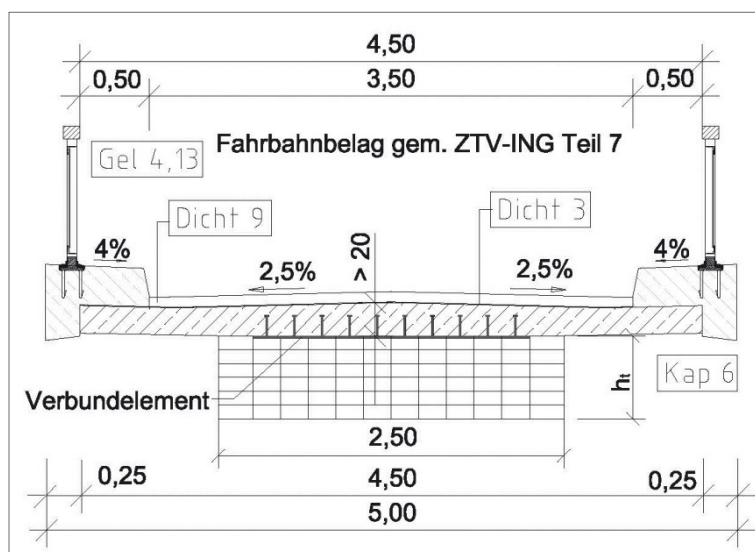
Regelquerschnitt einer Holz-Beton-Verbundbrücke
